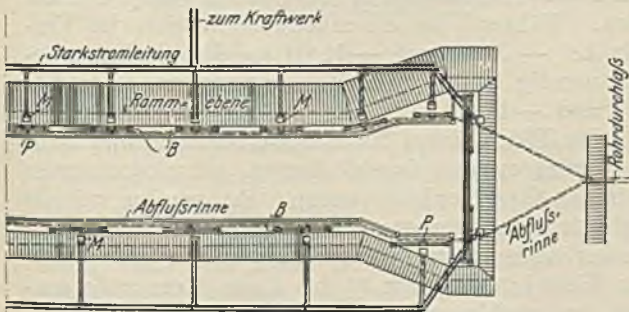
a. Grundriß der Anlage. Weitgehende Unterteilung der Wasserförderung.
